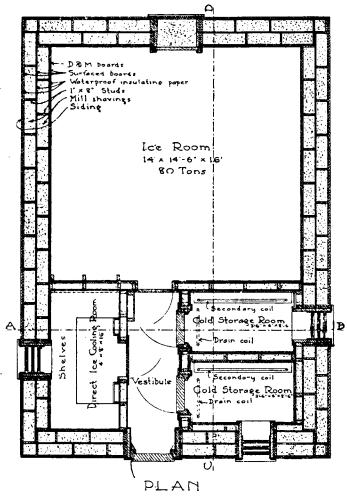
Планъ. D. & M. boards—Обшивочныя доски (обшелевка).—Surfaced boards—Чистыя доски.—Waterproof Insulating Paper—Водонепроницаемый изолировочный картонъ.—1"×8" Studs—Стойки 1"×8".—Mill. Shavings—Опилки.—Siding—Облицовка.—Ice Room—Льдохранилище. — Shelves—Полки. — Direct ice tooling гоот—Камера съ непосредственнымъ охлажденіемъ отъ льда.—Vestibule—Сѣни.—Secondary Coil—Вторичный змѣевикъ.—Cold Storage Room—Холодная камера.—Drain Coil—Сточная труба.
